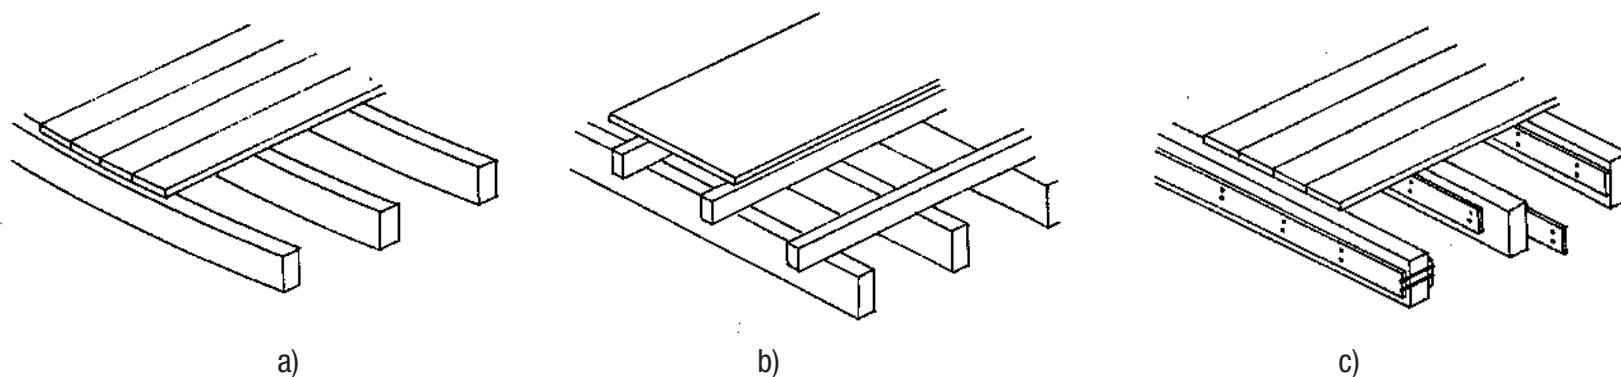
a), b) colocação de vigas transversais às vigas do pavimento; c) reforço de vigas por colocação de elementos metálicos.
